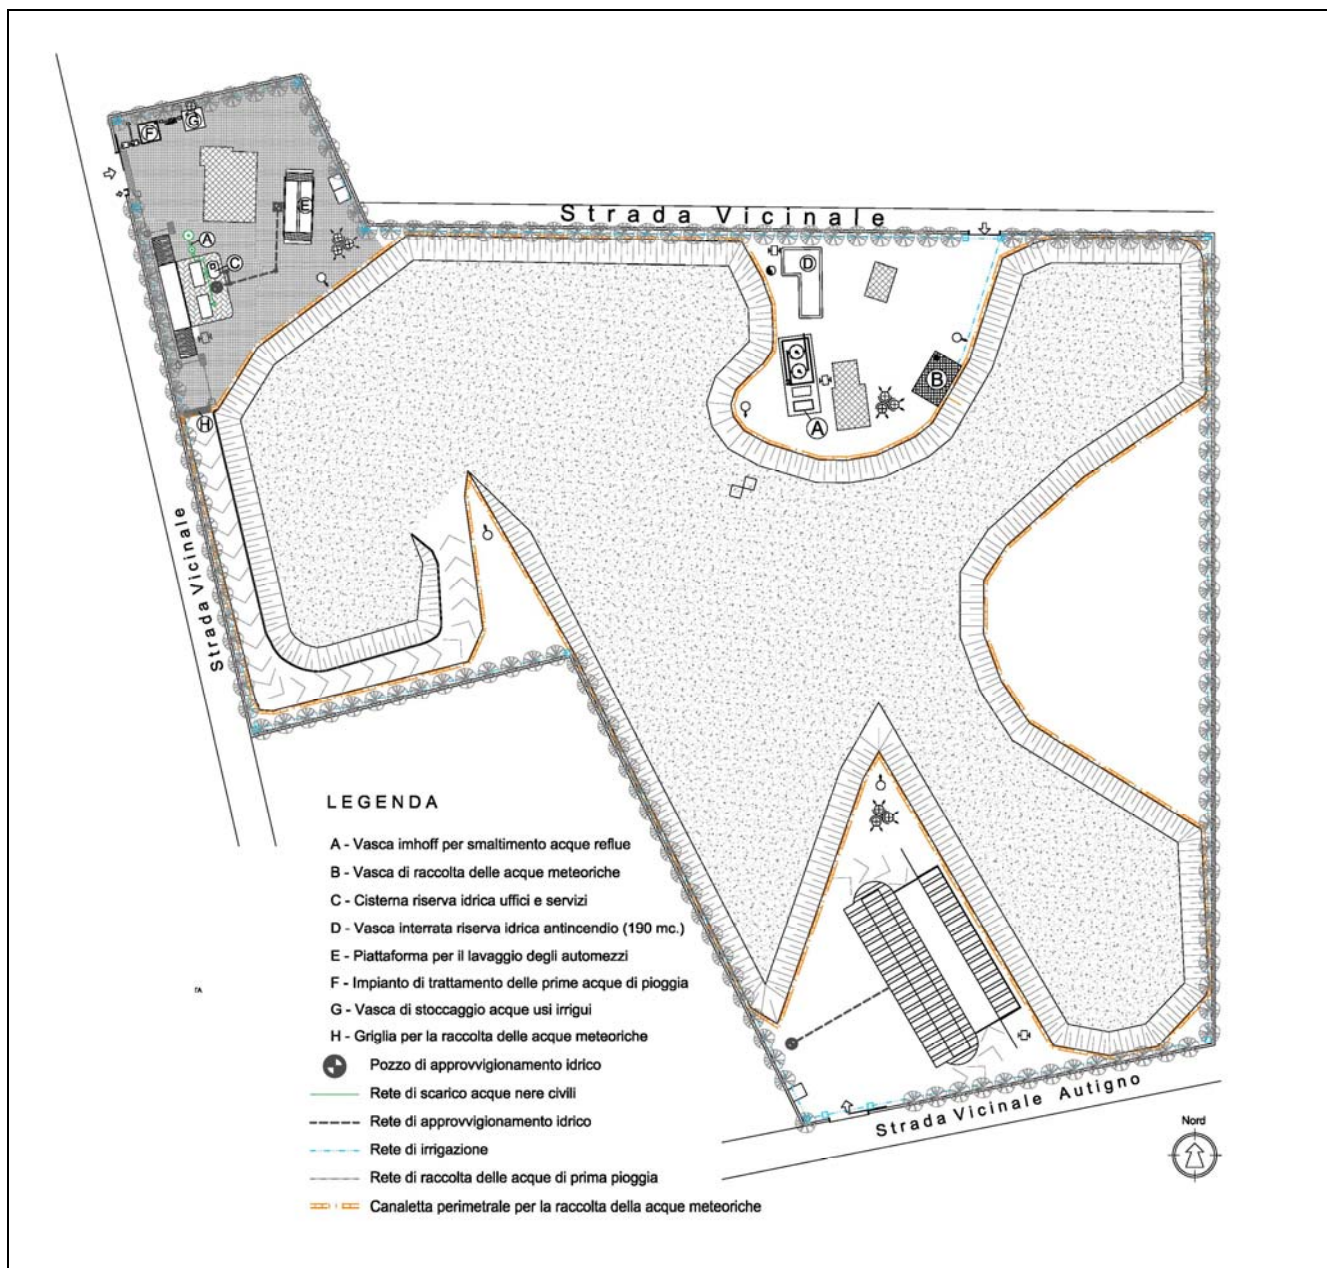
Planimetria rete idrica con individuazione punti di ispezione e punti di scarico
